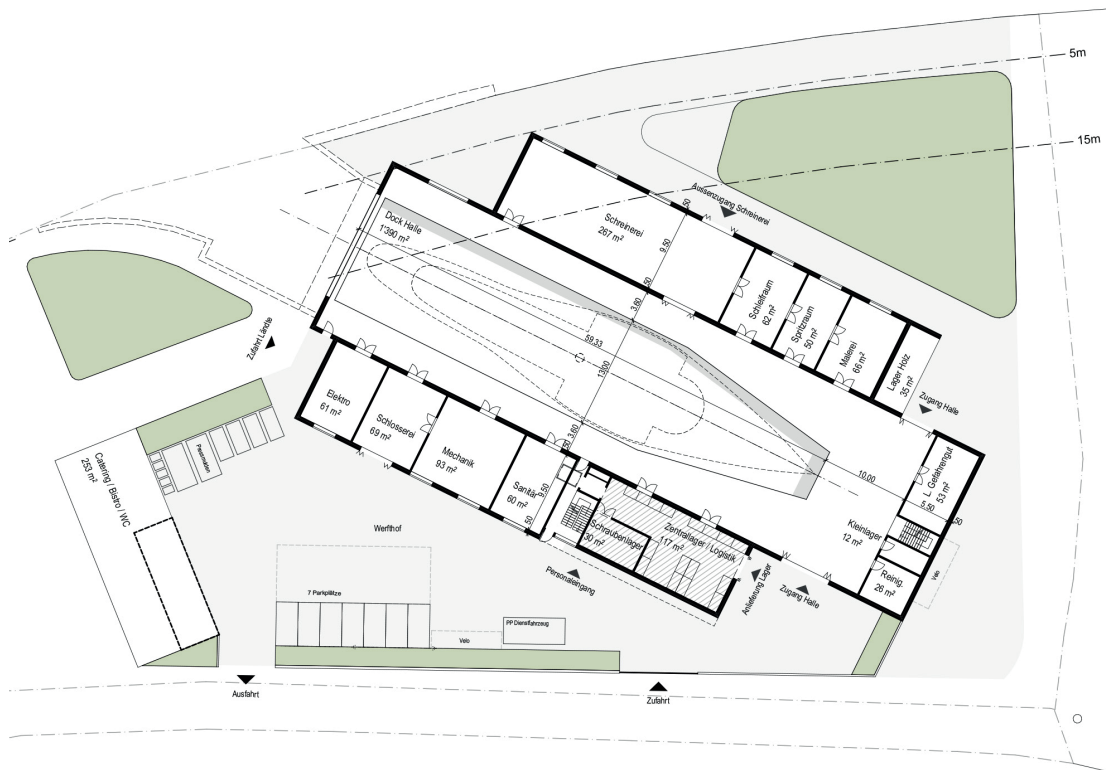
Werft und Werksareal im Situationsplan mit Konzeptgrundriss
